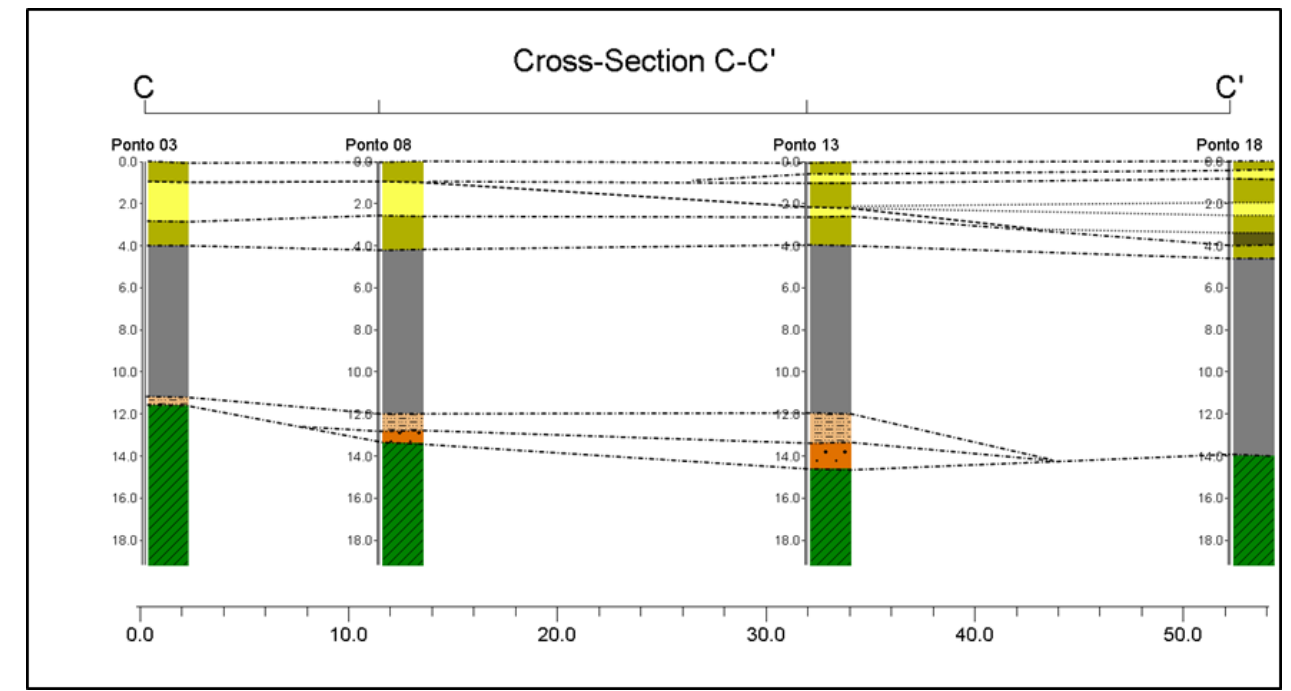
Perfil paralelo à Ria de Aveiro, dos pontos P3-18.
